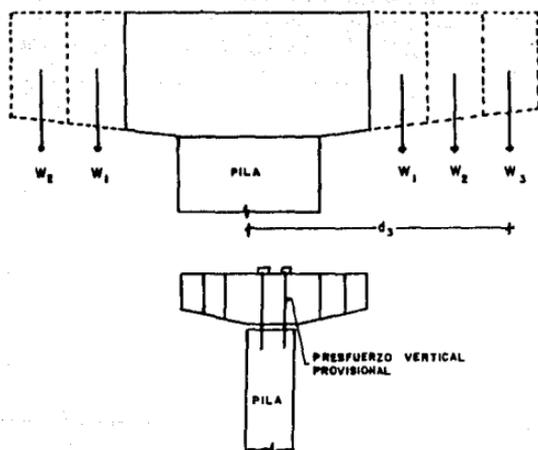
EQUILIBRIO EN CONSTRUCCION
